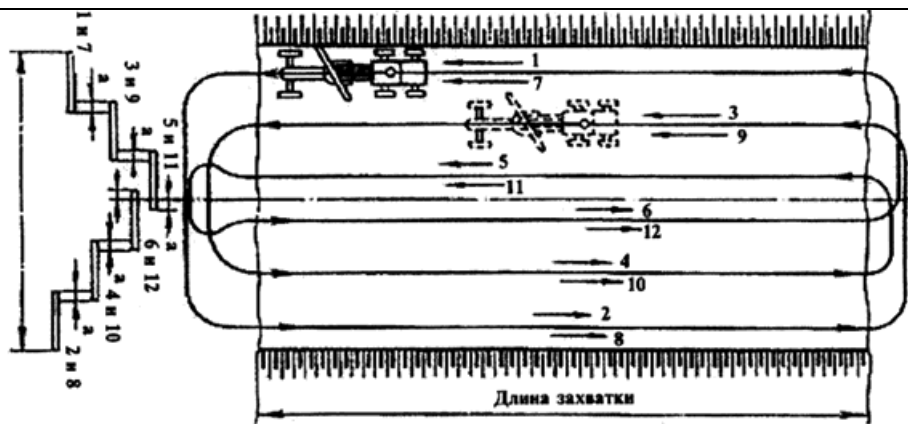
Послойное разравнивание грунта насыпи круговыми проходами
